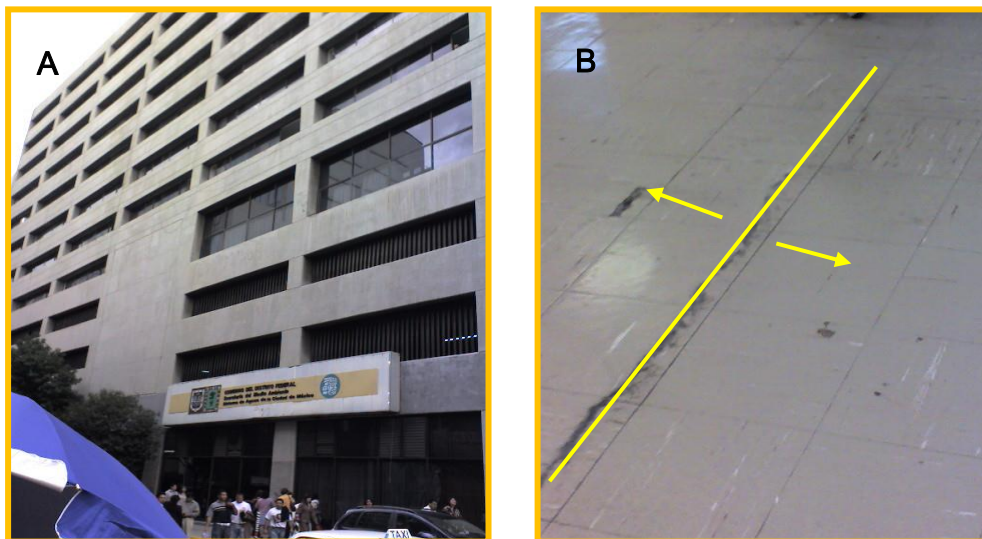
A) Fachada externa del Sistema de Aguas de la Ciudad de México y B) Fisuramiento de pisos dentro de las instalaciones del inmueble.
